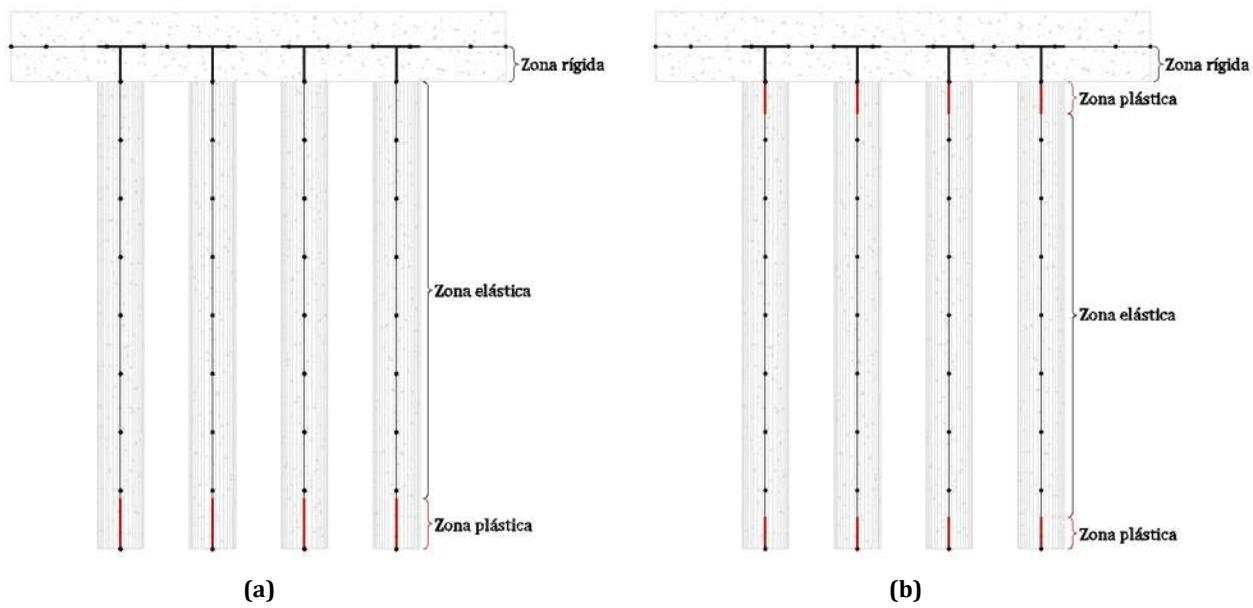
Modelo de zona plástica para pilas, en dirección: (a) longitudinal, y (b) transversal
